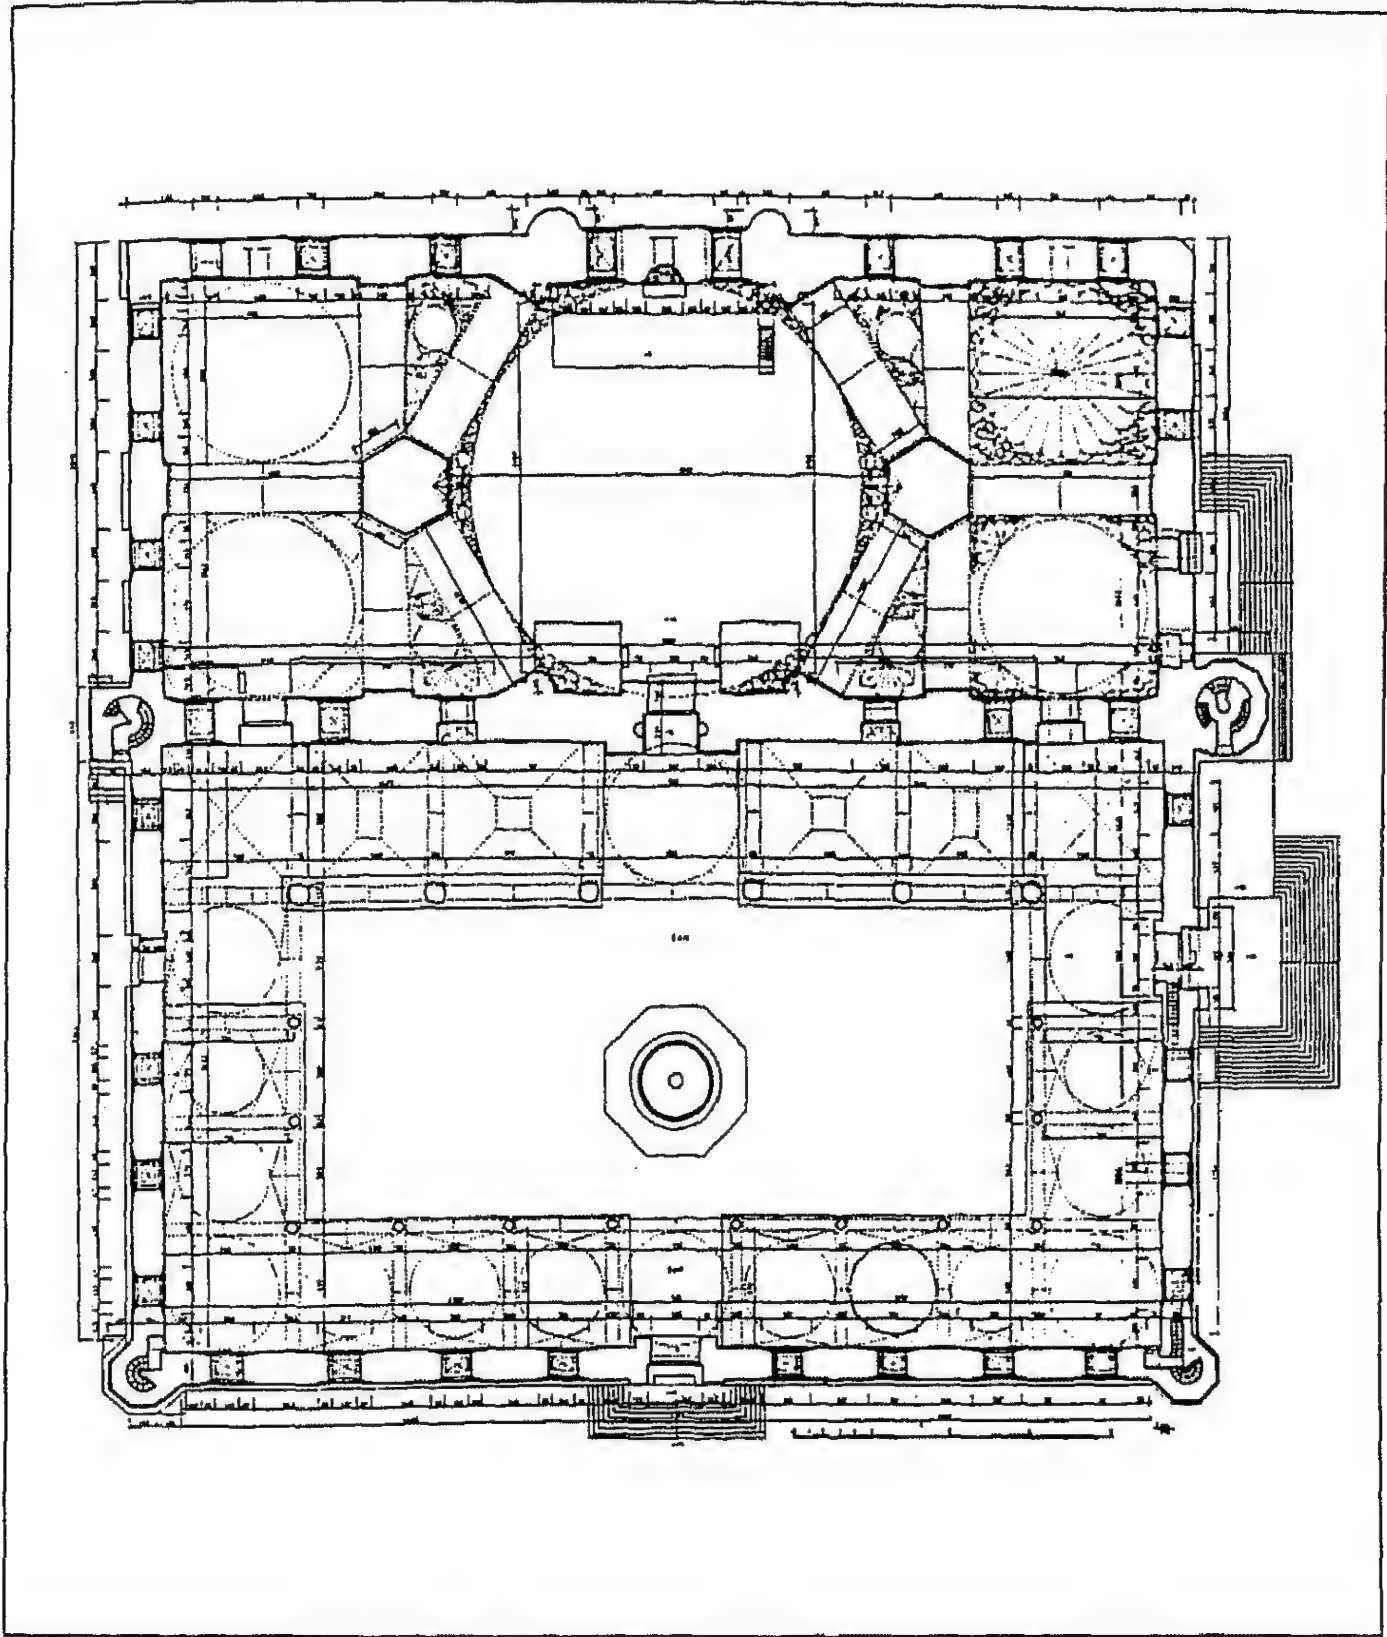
مسقط أفقي للمسجد العتيق (اسكى جامع) في يامبول (عن : كيل) .
